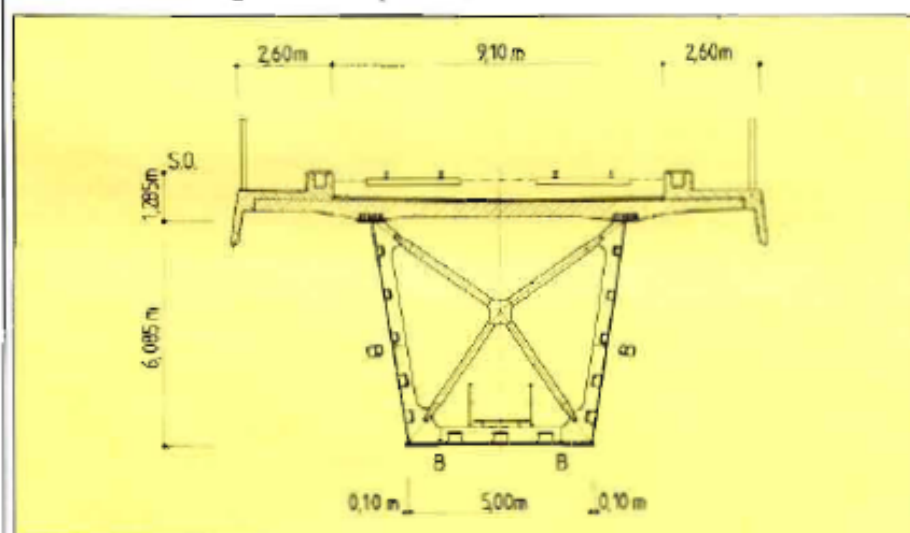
Puente FF.CC. en Alemania. Sección transversal.
